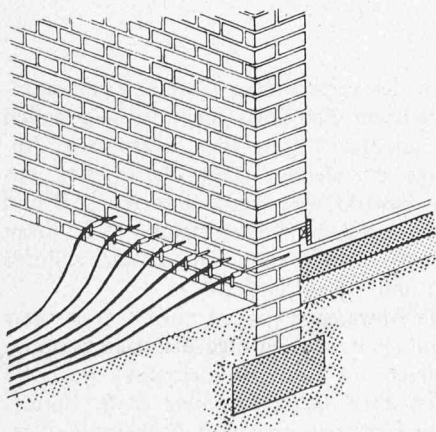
Horizontale Injektionen mit zentral verbundenen Eingussröhrchen
